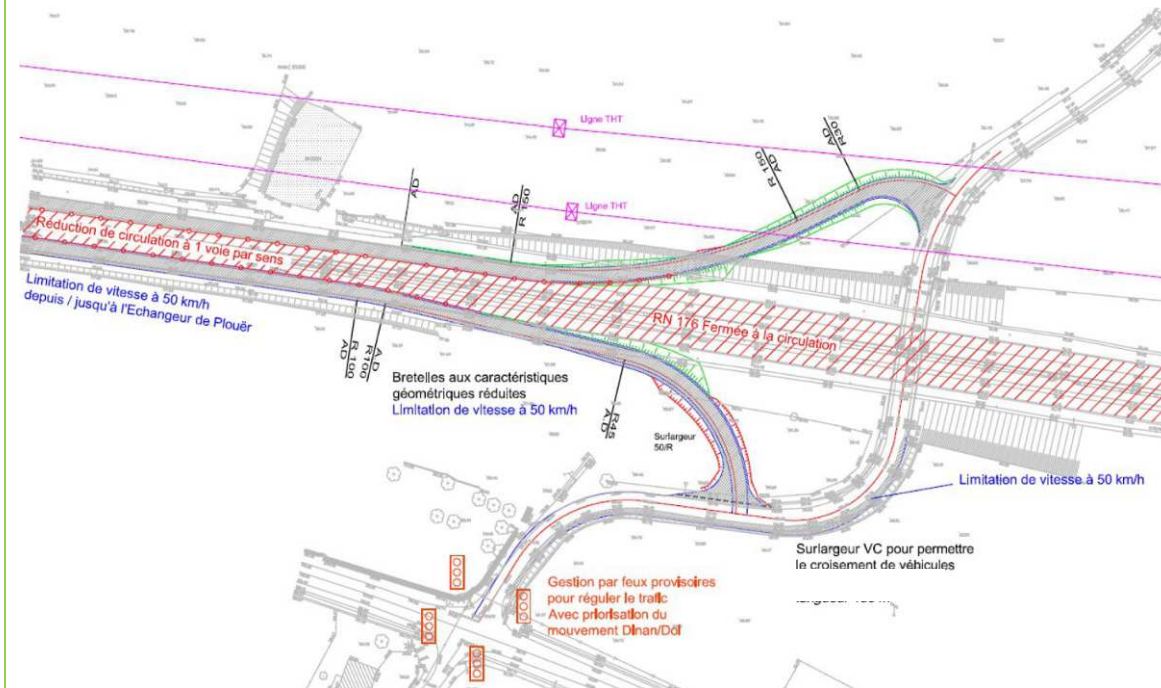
Bretelles provisoires au droit de la VC de la Boisanne (source ARCADIS)
